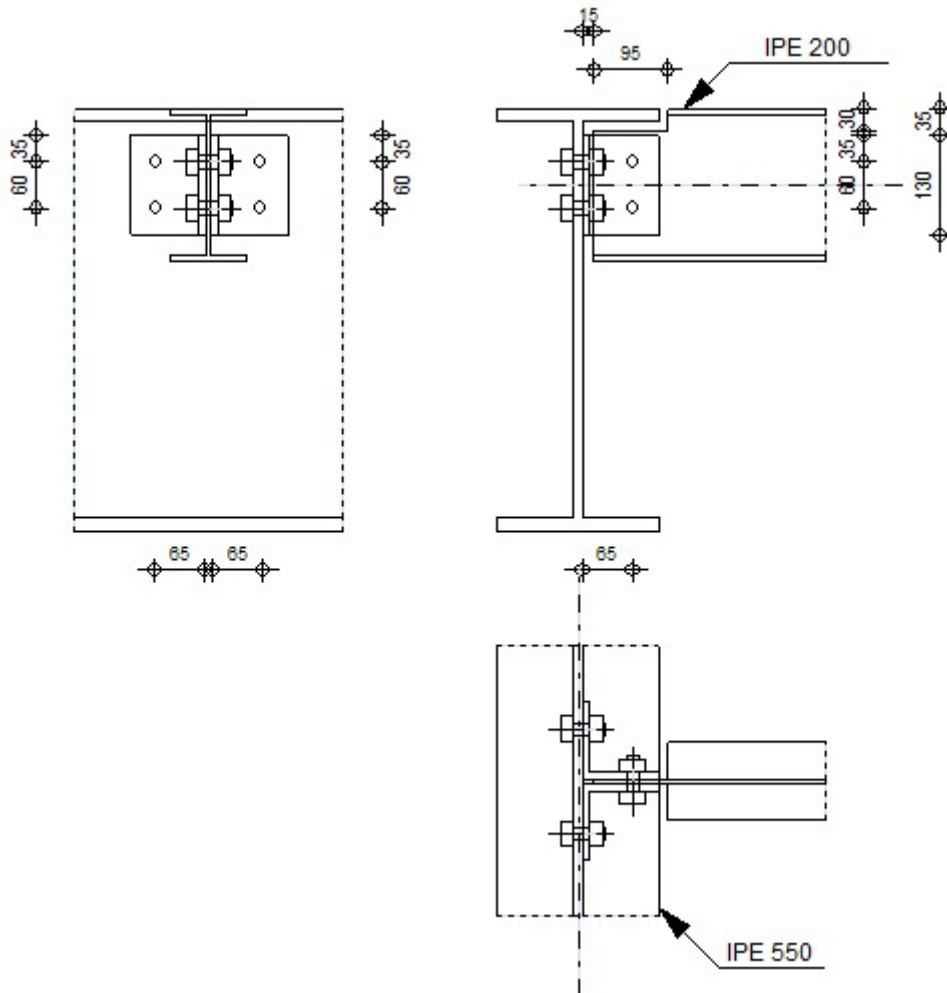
assemblage poutre solive (IPE 550-IPE 200)
